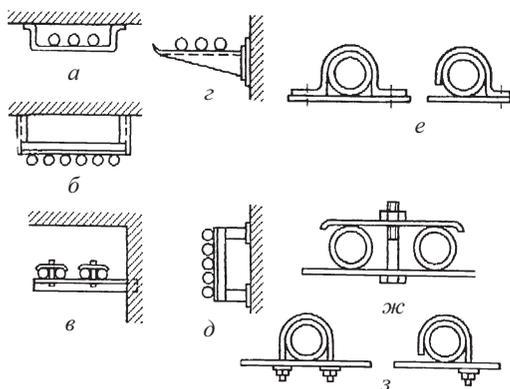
Опорные и крепежные конструкции для трубных проводов:
